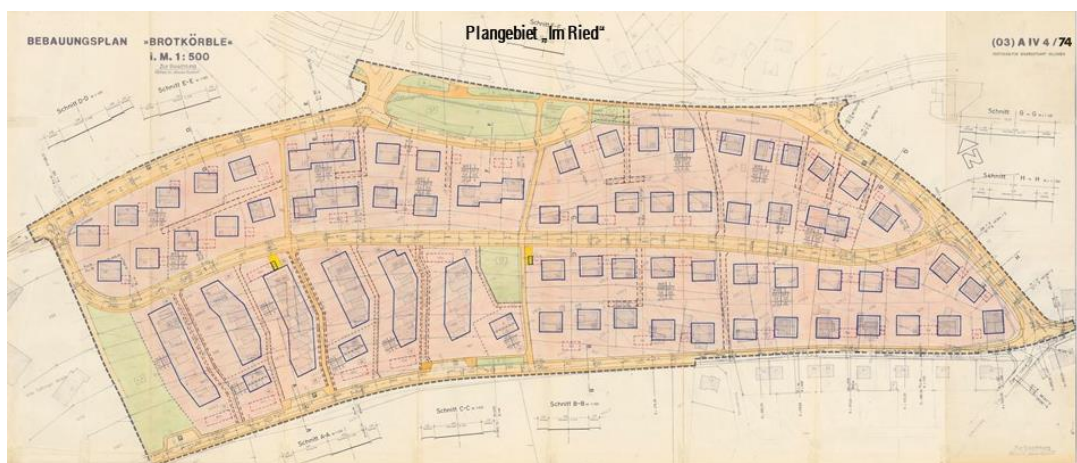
Ausschnitt Bebauungsplan „Brotkörble I“ aus dem Jahr 1986, Stadt Villingen-Schwenningen, südlich des Plangebiets „Im Ried“
